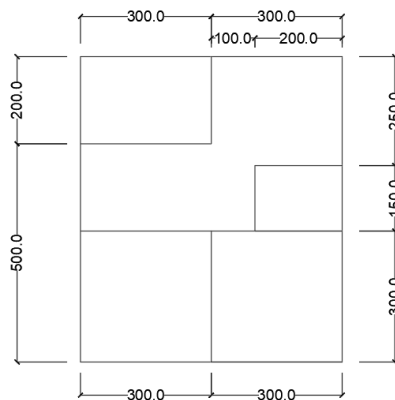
Tampak atas rancangan susunan Blok Batu pada pondasi menerus
